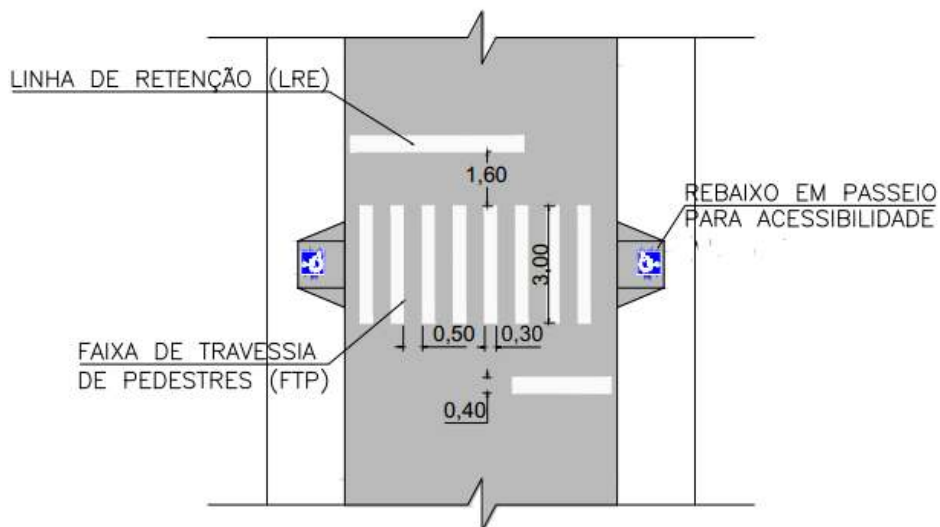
Faixa de Travessia de Pedestres do Projeto.
